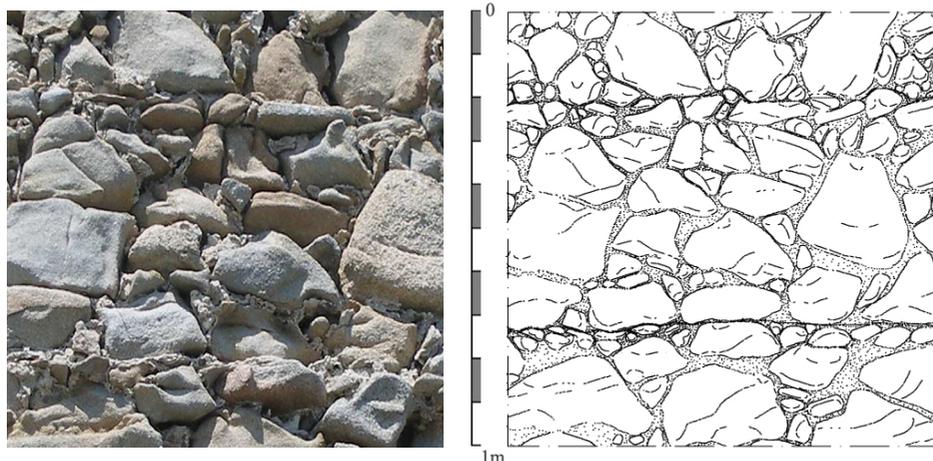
Campione murario. Foto raddrizzamento e rilievo architettonico.
